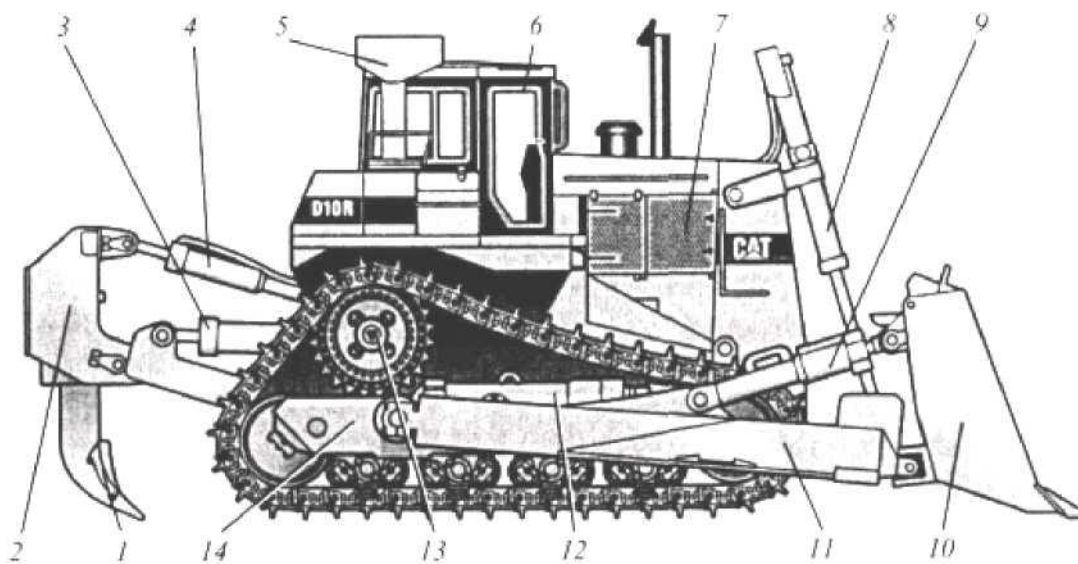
Гусеничный бульдозерно -рыхлительный агрегат с треугольным контуром гусениц: 1 - зуб рыхлителя; 2 - рама рыхлителя; 3 - гидроцилиндр подъема/опускания рыхлителя; 4 - гидроцилиндр наклона зуба рыхлителя; 5 - конструкция ROPS; 6 - кабина; 7 - моторный отсек; 8 - гидроцилиндр подъема/опускания отвала; 9 - гидравлический подкос; 10 - бульдозерный отвал; 11 - толкающий брус; 12 - гидроцилиндр натяжения гусеницы; 13 - ведущая звездочка; 14 - рама гусеничной тележки
